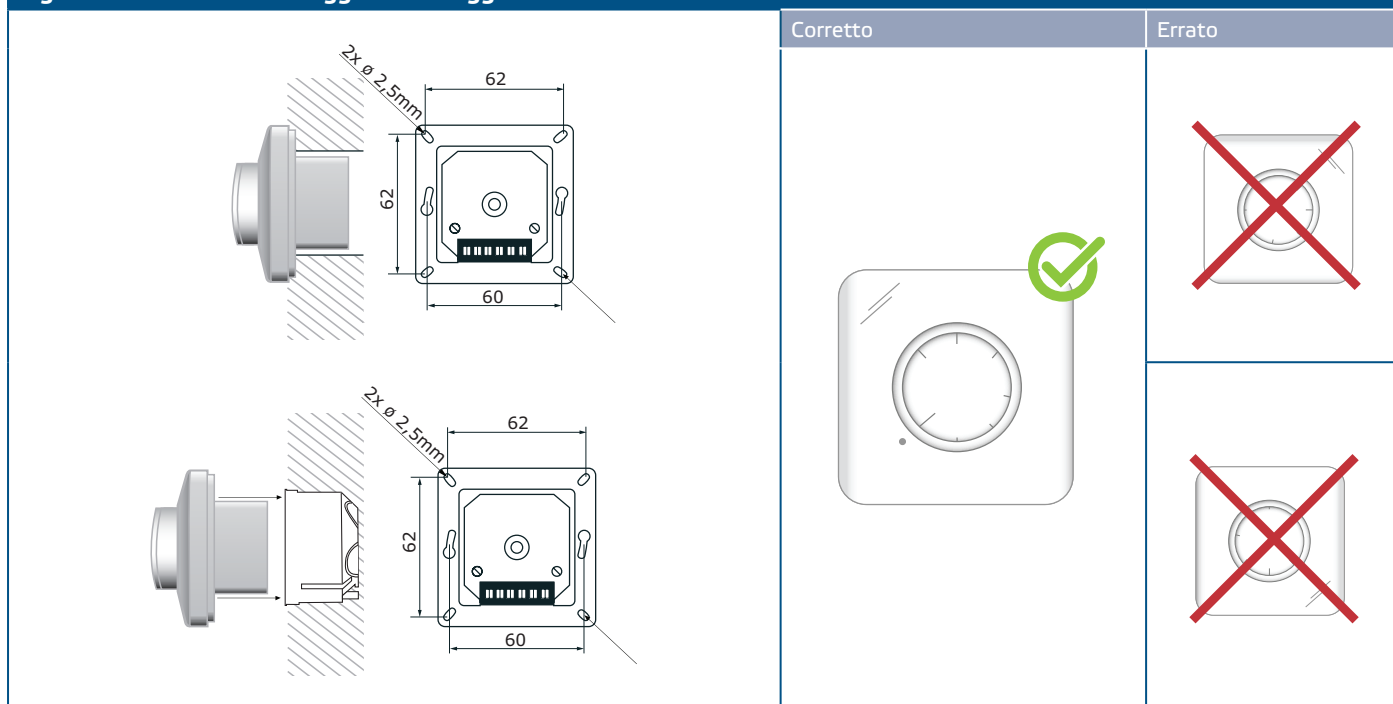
Dimensioni di montaggio - montaggio a incasso
